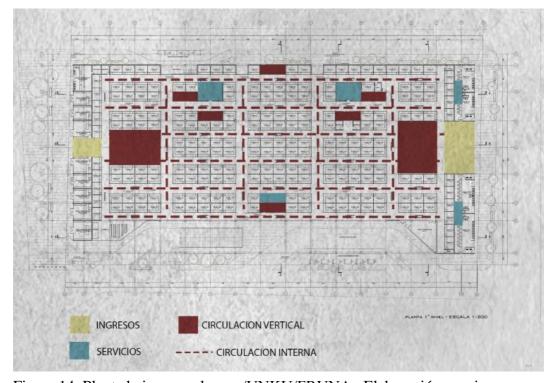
Planta baja mercado por /UNKU/FRUNA. Elaboración propia
